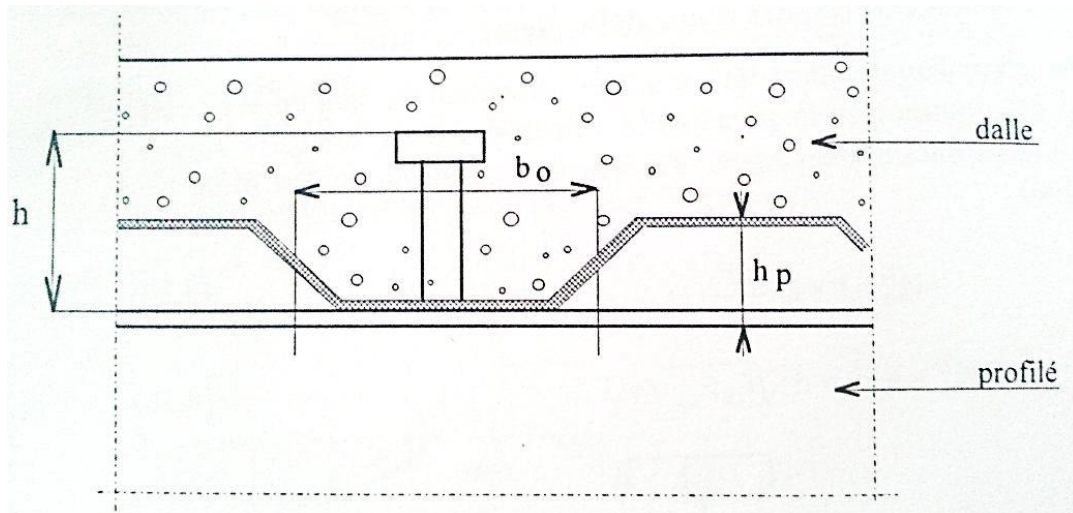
Goujon soudé avec dalle mixte
